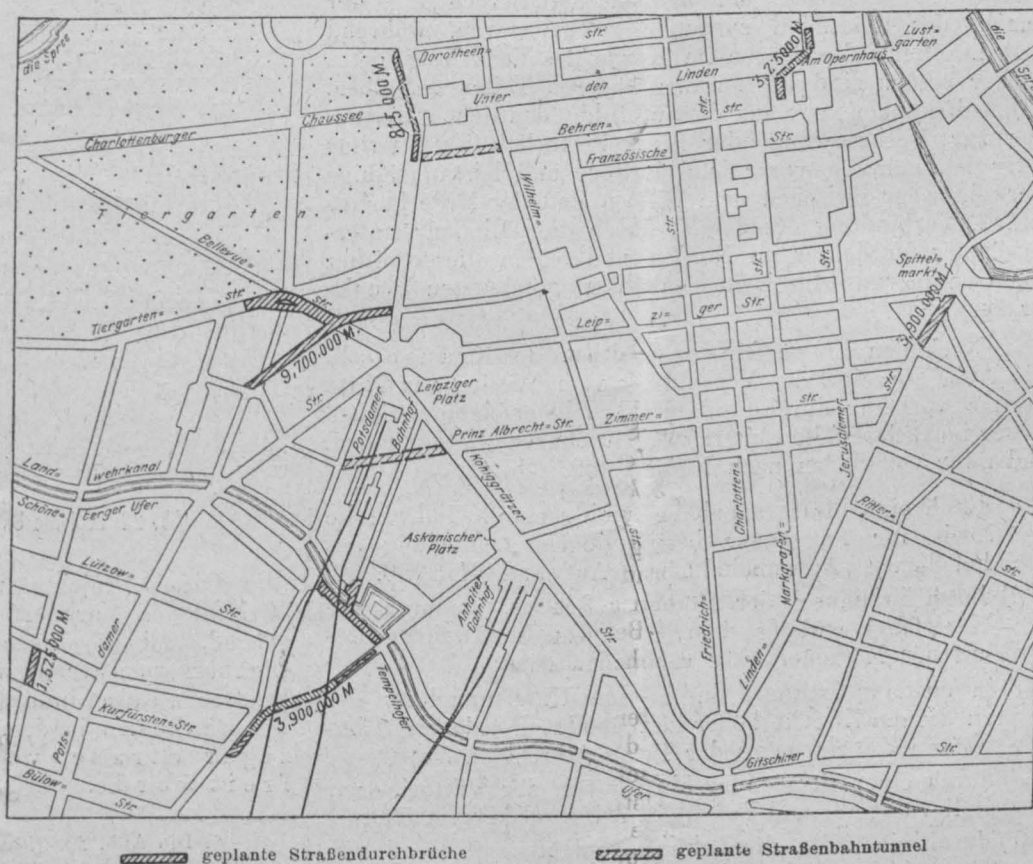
Plan von Berlin mit den geplanten Straßendurchbrüchen und Straßenbahntunnels
